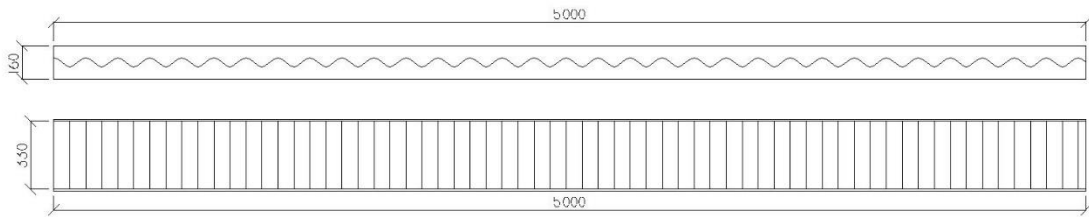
Trapezoidal gövdeli ondülin kiriş 330 (TGOK_330) boykesit detayı
